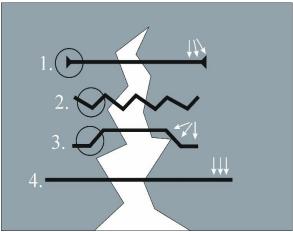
Схема анкеровки стальных фибр различных форм в цементном камне: 1 - фибра с конусовидными концами; 2 — волновая фибра; 3 — фибра с загнутыми концами; 4 — прямая фибра: кружки — механизмы анкеровки фибры; стрелки — поверхности сцепления [12]
